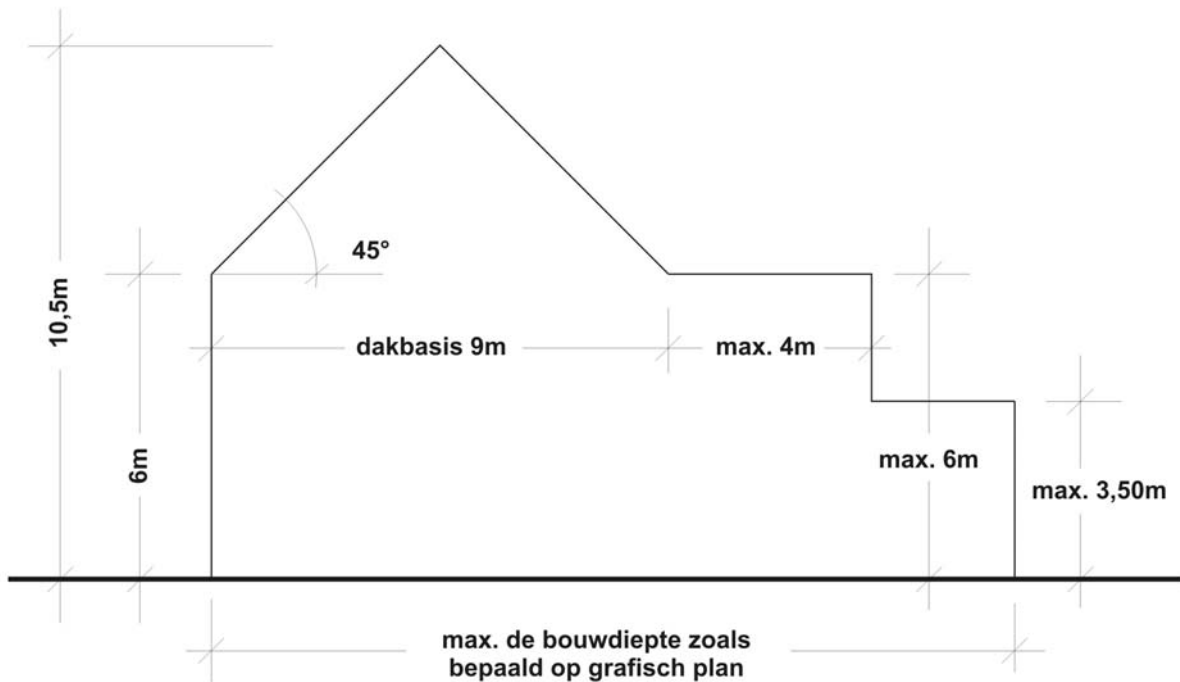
aaneengesloten bebouwing: plaatsing gebouwen
